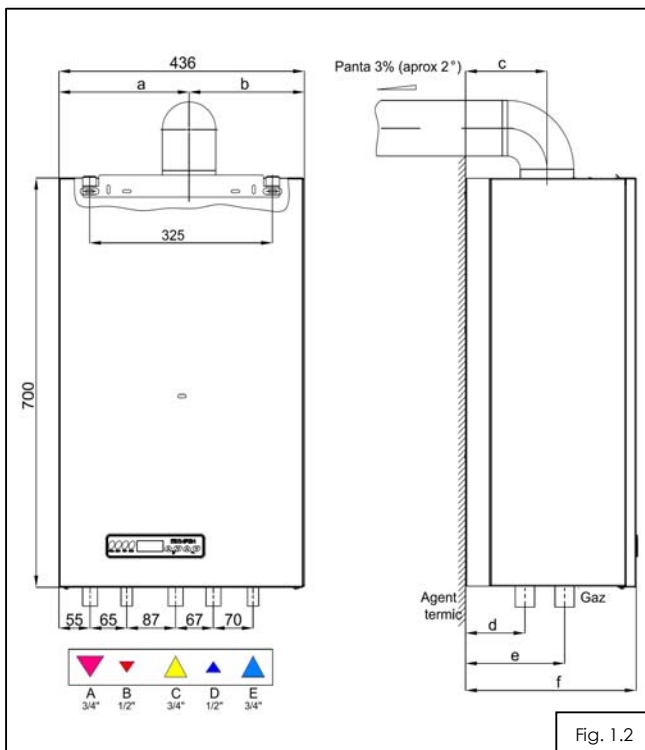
Dimensiuni de gabarit si pozitii de montaj
